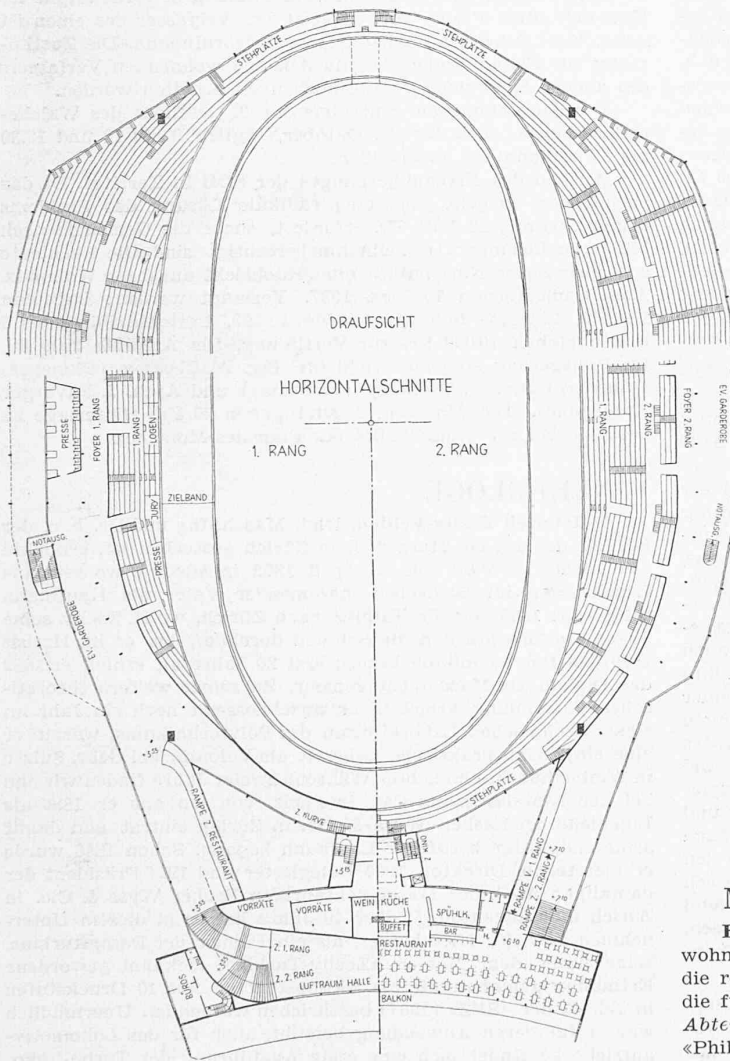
Grundriss vom 1. und 2. Rang mit Draufsicht. — 1 : 1000
